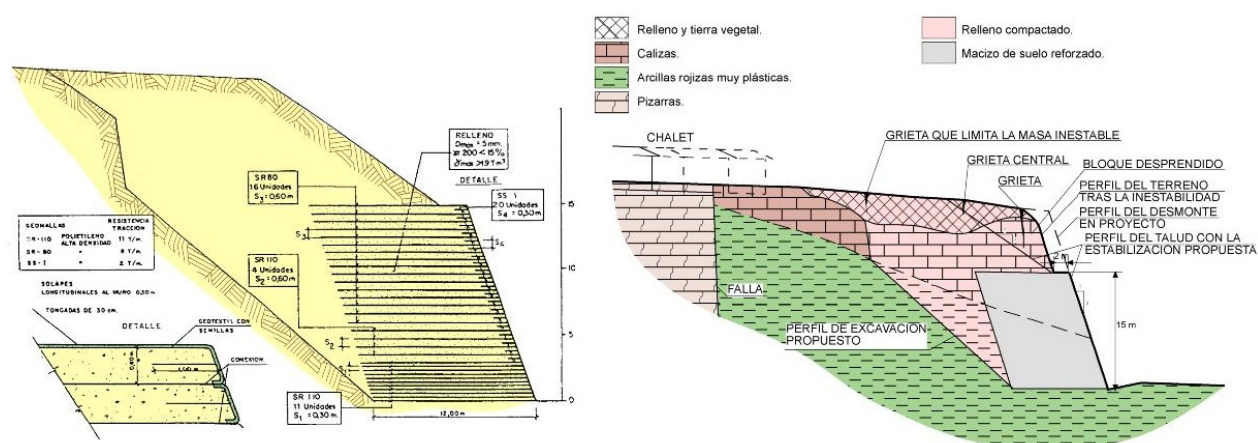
Detalle de una propuesta de estabilización mediante suelo reforzado en la Ronda Este de Málaga.
